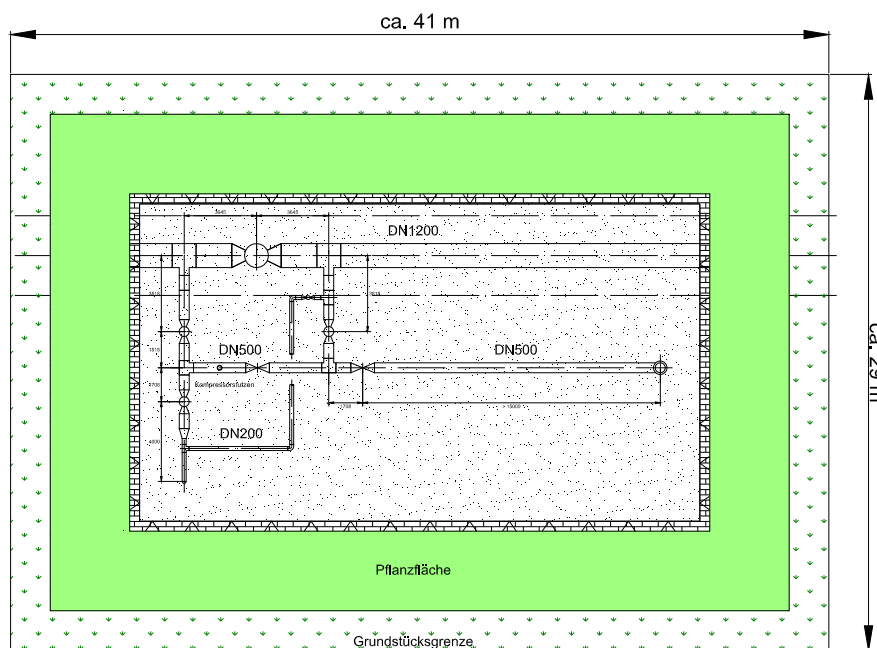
Schematische Darstellung einer Streckenabsperrstation mit Abzwegleitung
